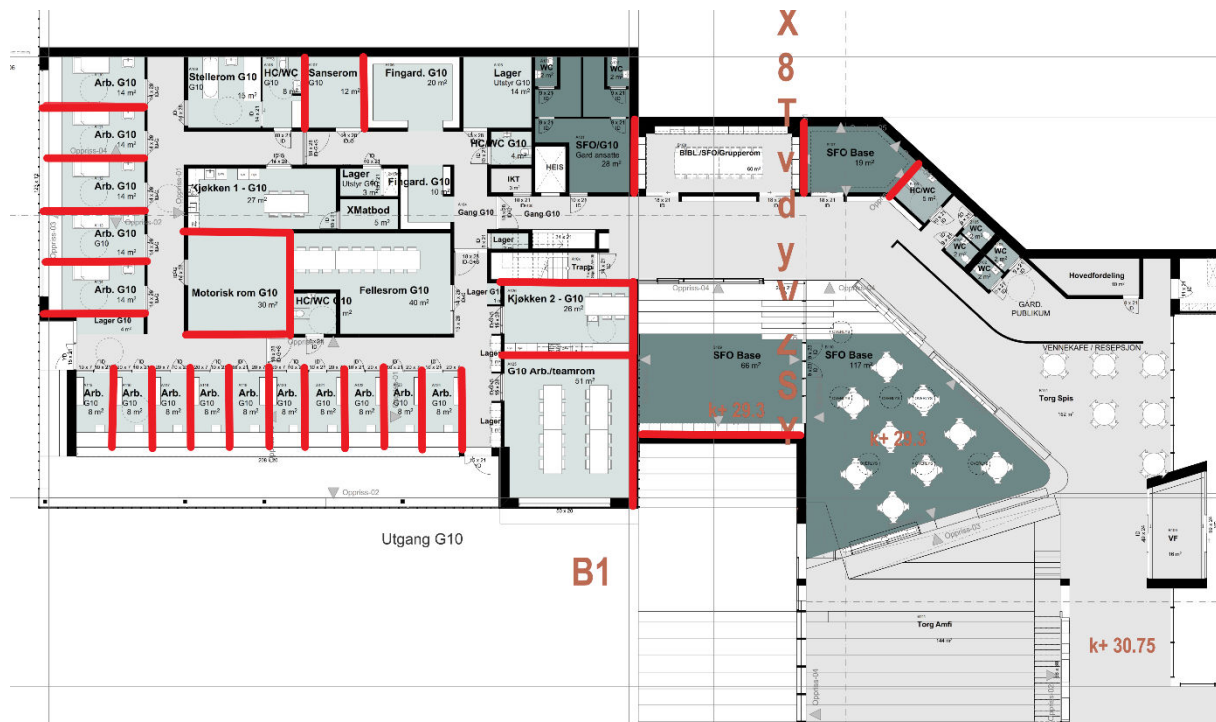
Utsnitt av plantegningen for Plan U som foreligger p.t. Behovet for splitt i betonggulvet er skissert med røde streker på planen. En ny vurdering av hvor det må splittes i betongen må utføres i totalentreprisen når endelig planløsning og tykkelse på betonggulv foreligger.
